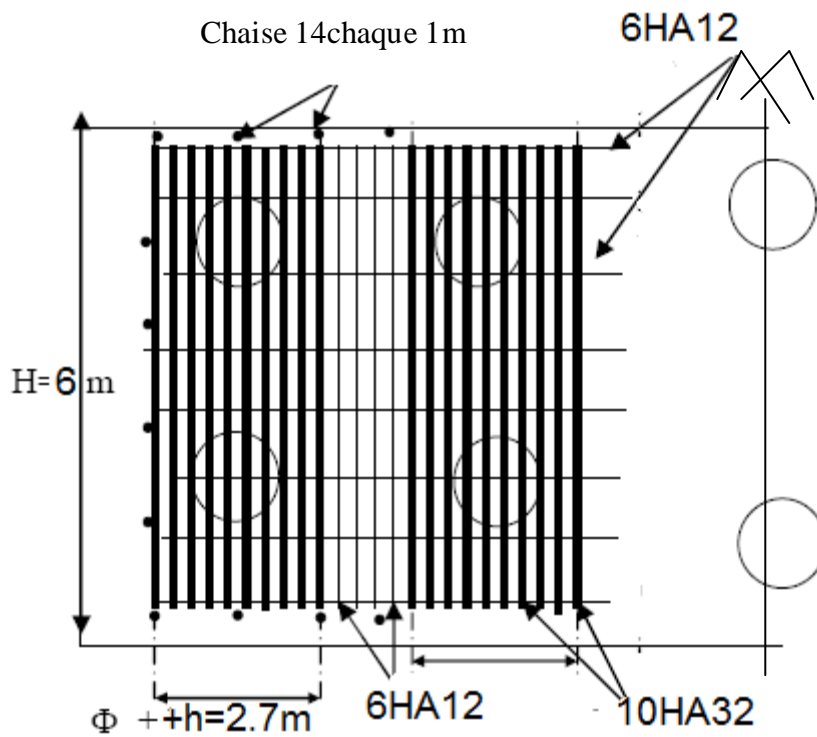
Ferrailage de la semelle (nappe inférieure).
